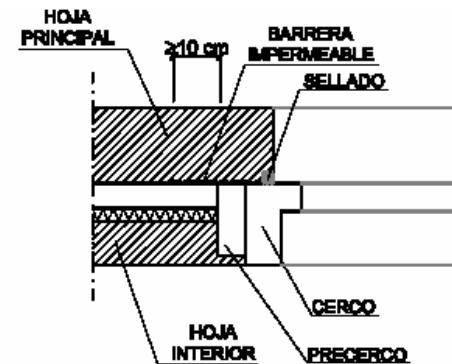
Ejemplo de encuentro de la fachada con la carpintería
